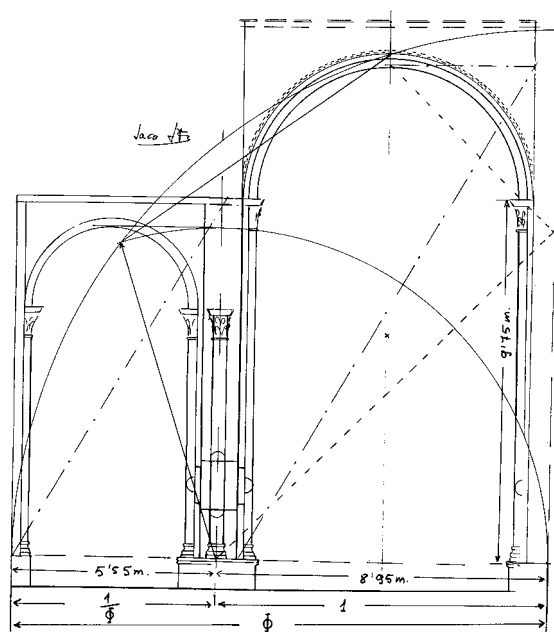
Alzado norte-sur del crucero, nave lateral norte y nave central. Catedral de Jaca.
